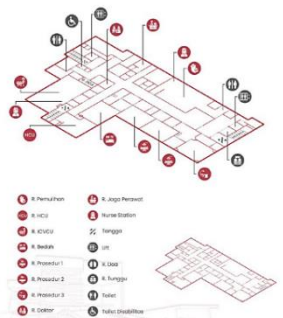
Denah Bangunan RSJP Paramarta (Lantai 1)
